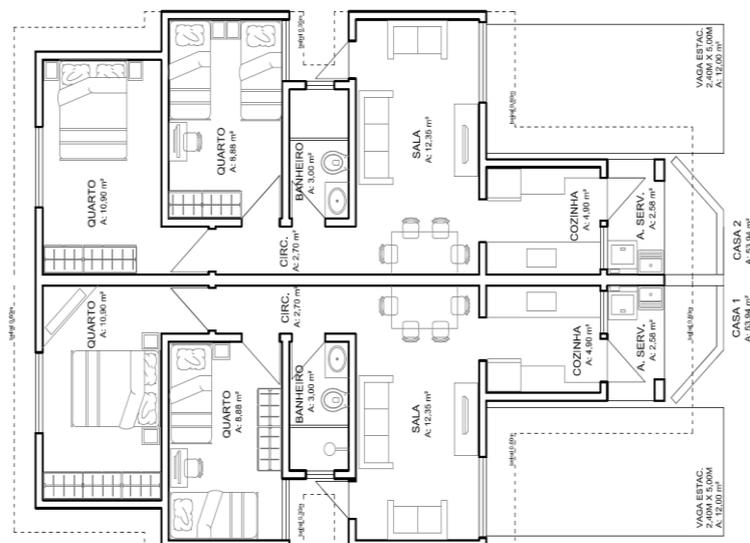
Planta baixa do estudo de caso. Fonte: elaborado pelos autores.
